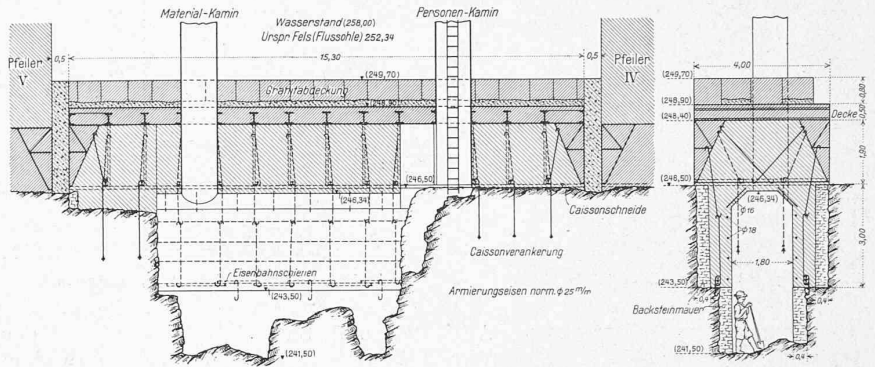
Unterfahrung einer Caissonschnede mit Eisenbeton am Stauwehr Augst-Wyhlen. — 1 : 200. Entwurf und Ausführung A. G. Conrad Zschokke, Genf. [Aus der „S. B. Z.“ vom 12. April 1913.]
